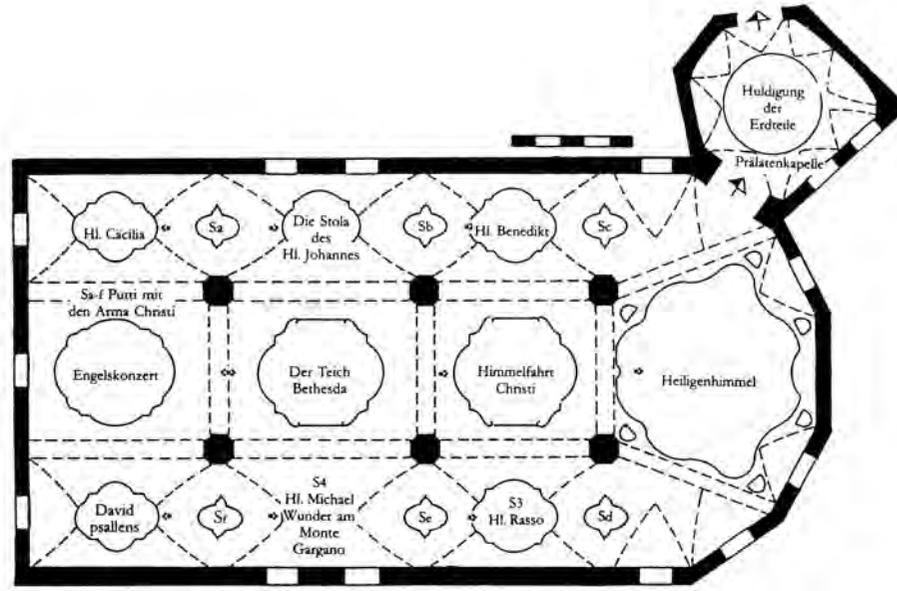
Kloster Andechs, Grundriss der Wallfahrtskirche
